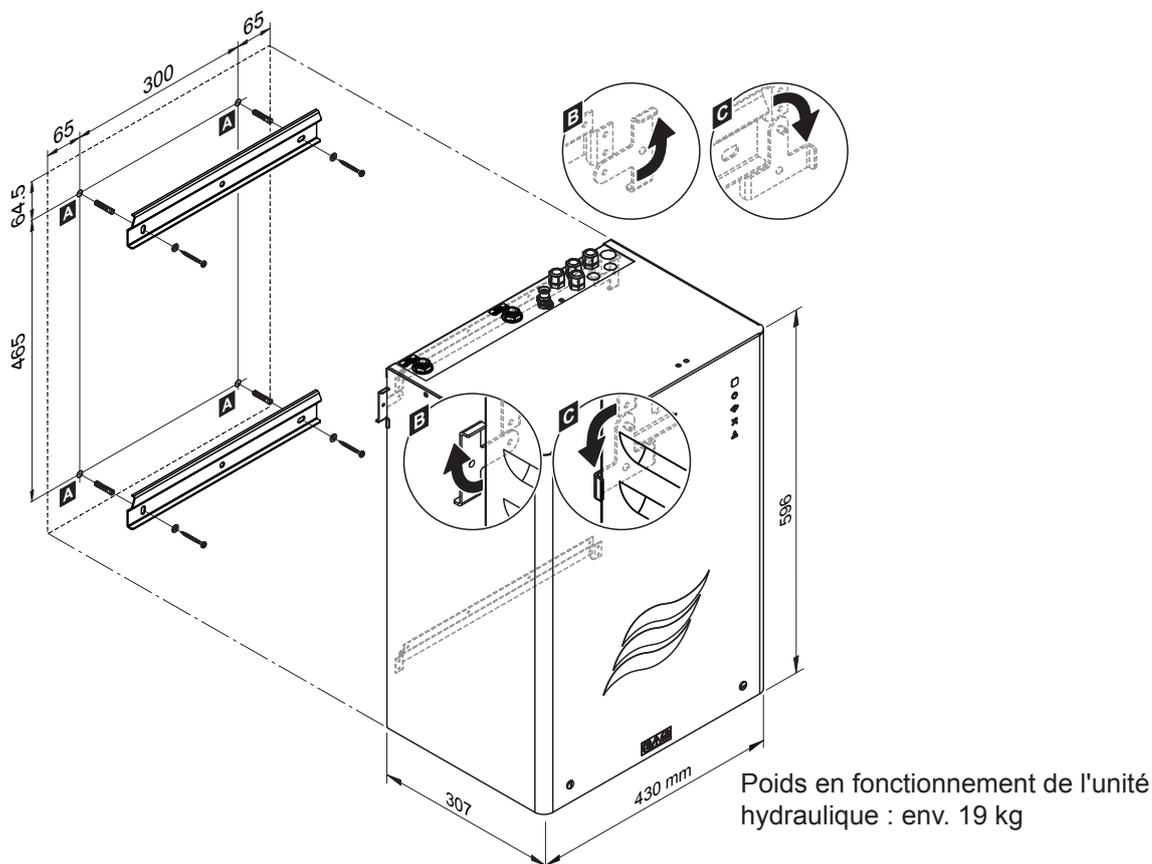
Montage de l'unité hydraulique (dimensions en mm)
